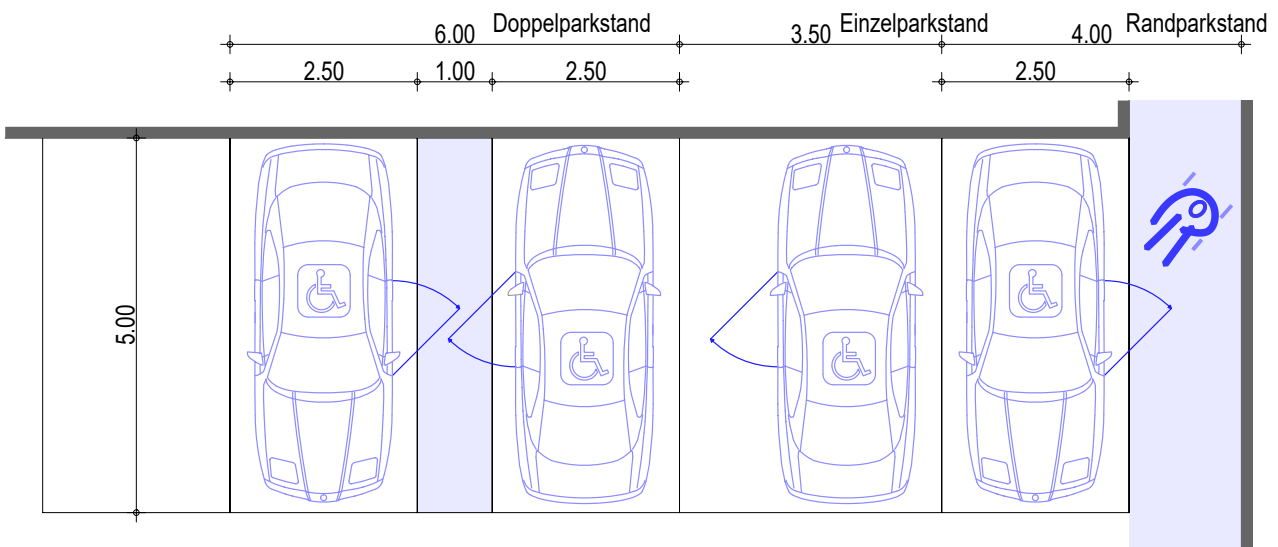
Parkplätze mit Ein- und Ausstiegsflächen, inkl. „Flächensparmodell“
